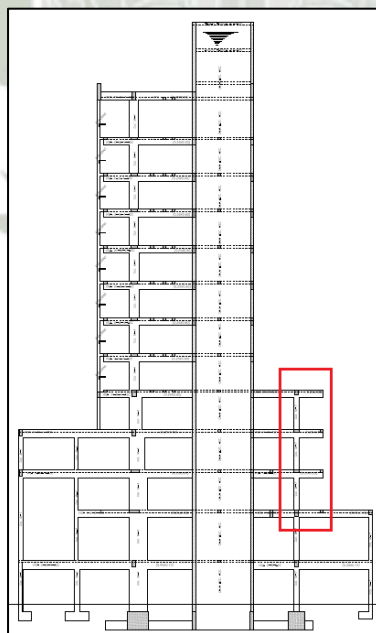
CORTE ESTRUCTURAL MUESTRA PARTE CON TABIQUERÍA MÁS AFECTADA
